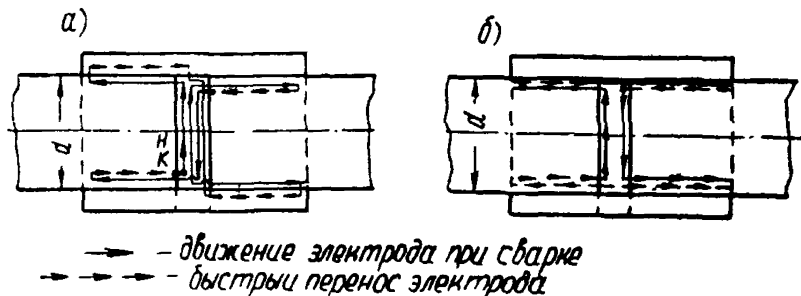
Схема движения электрода при одновременной ванно сварке стыка и наплавке фланговых швов стержней диаметром менее 60 мм
